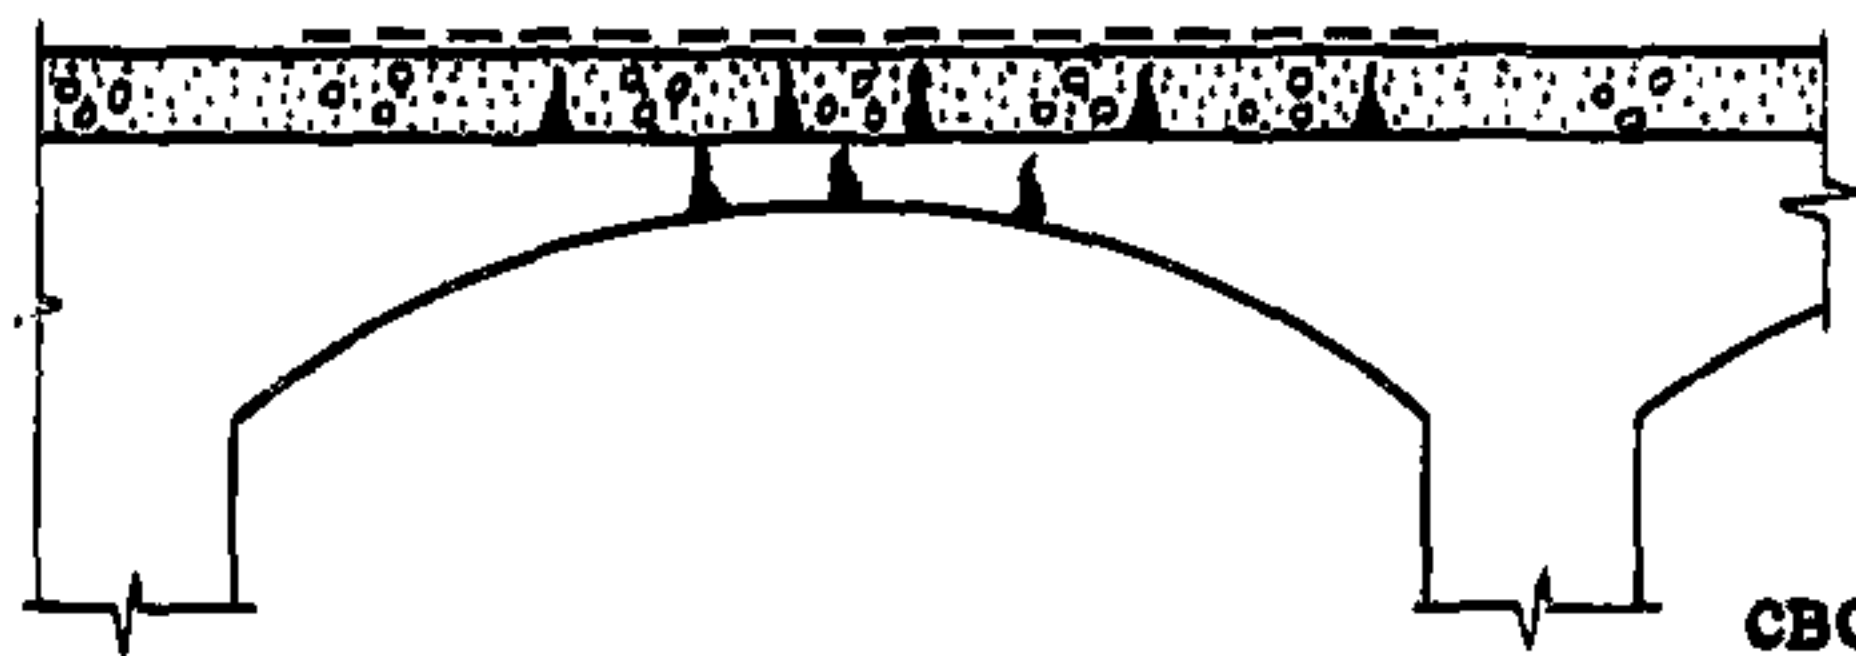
Трещины в перекрытии на железобетонных сводчатых плитах и выпучивание в зонах металлических балок
